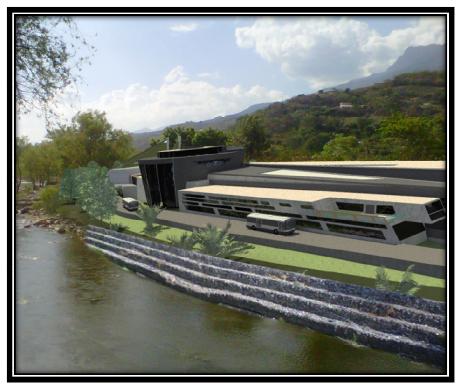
Propuesta Arquitectónica. Perspectivas del Conjunto.
